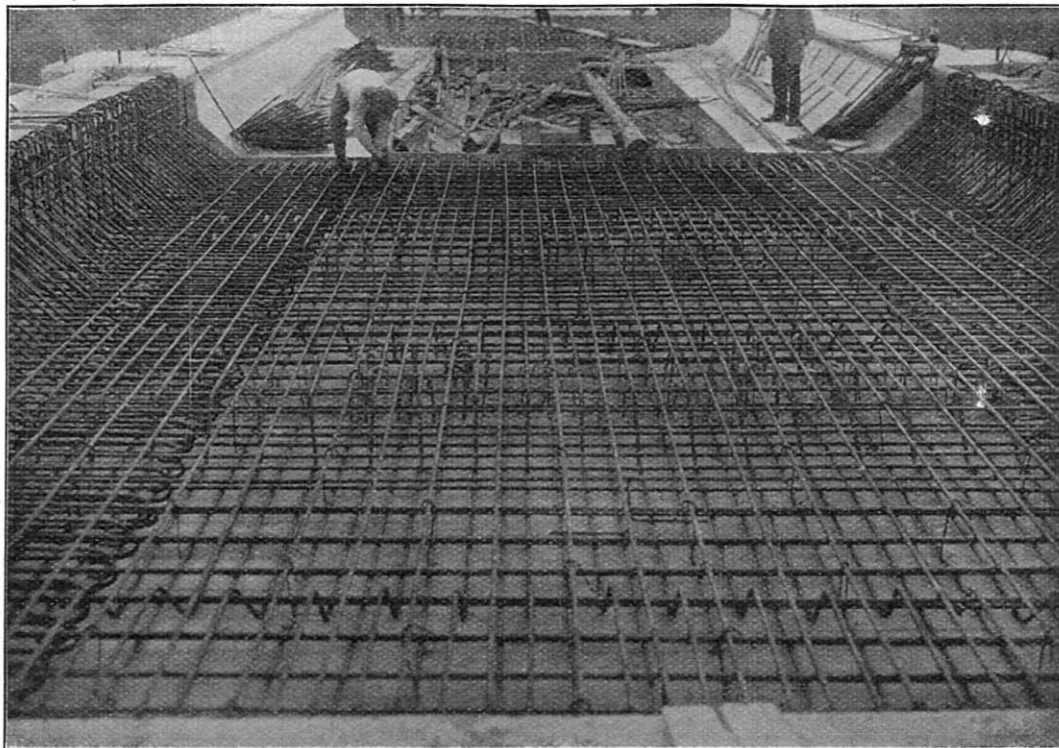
Viaduc de la Pède. — Ferrailage de l'encuvement.
